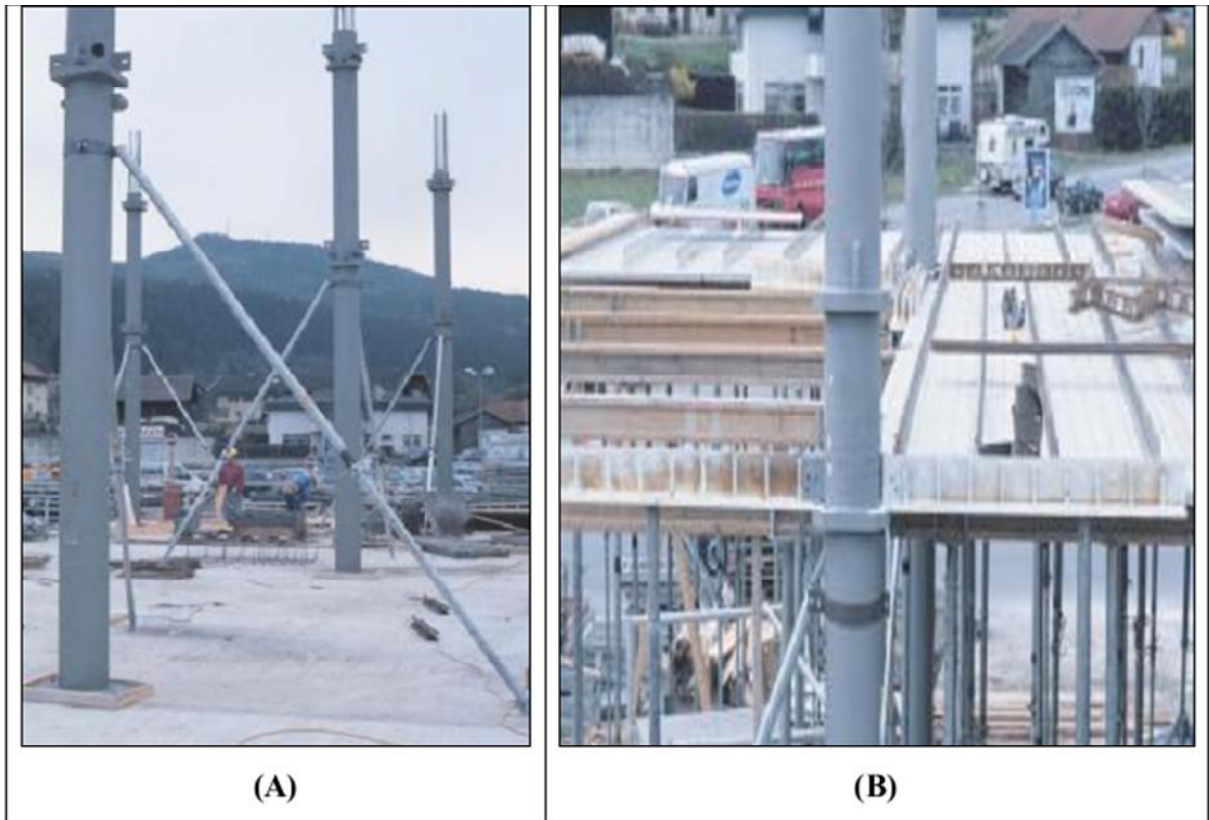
(A)-Elévation de poteaux mixtes sur 2 étages
